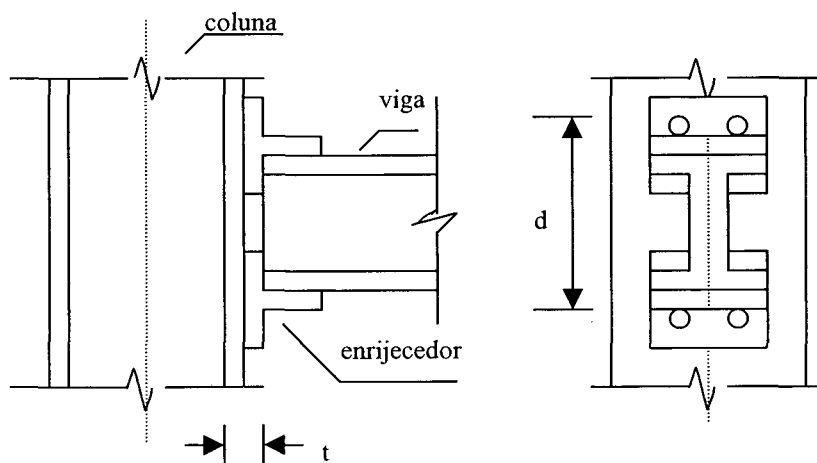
Típica conexão viga-pilar metálica “tee-stub”.
